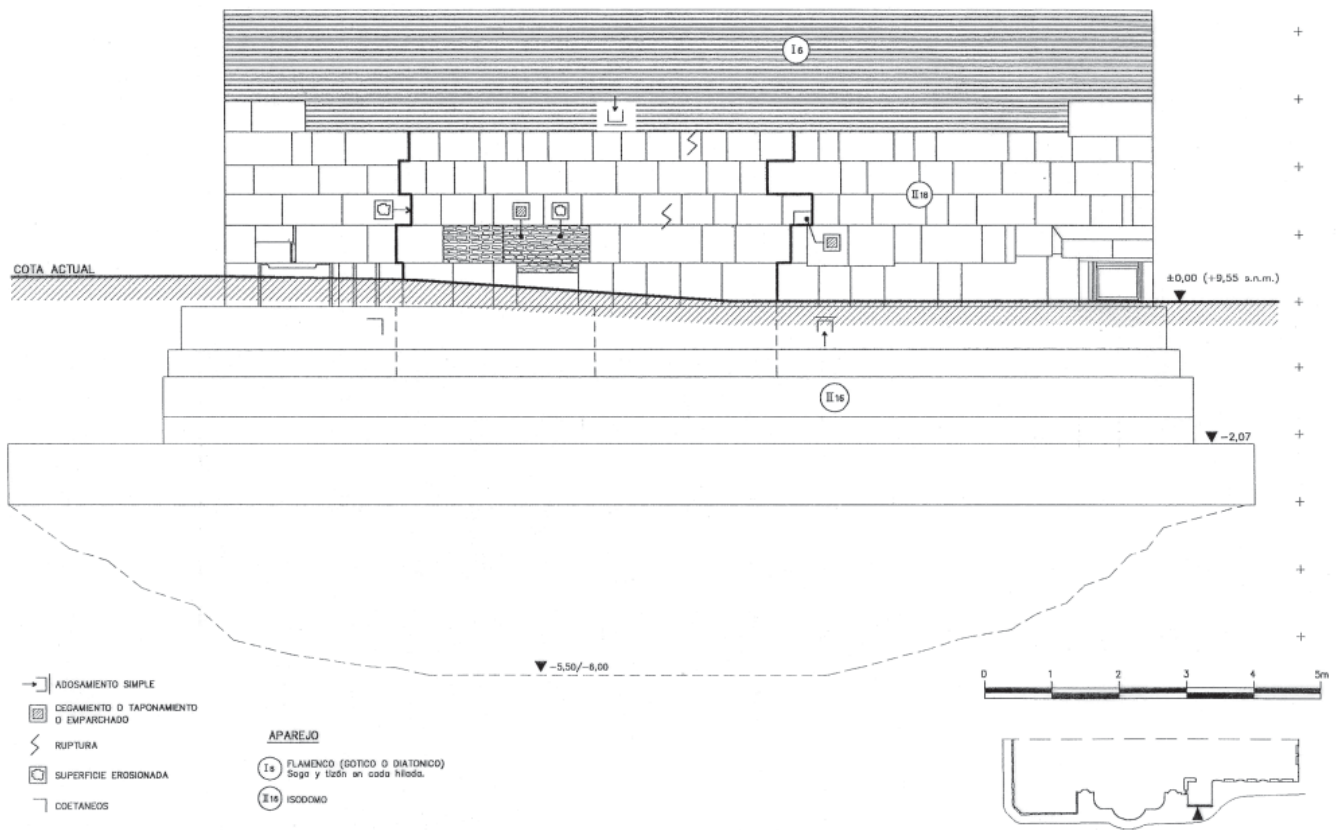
Cara Este de la Giralda. Alzado tipológico-estructural.
